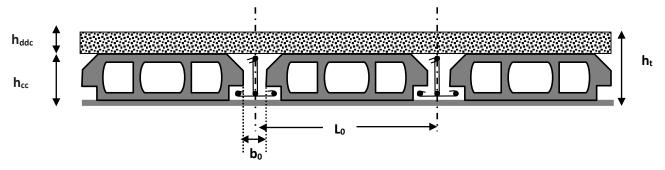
Coupe transversale sur un plancher à corps creux.
